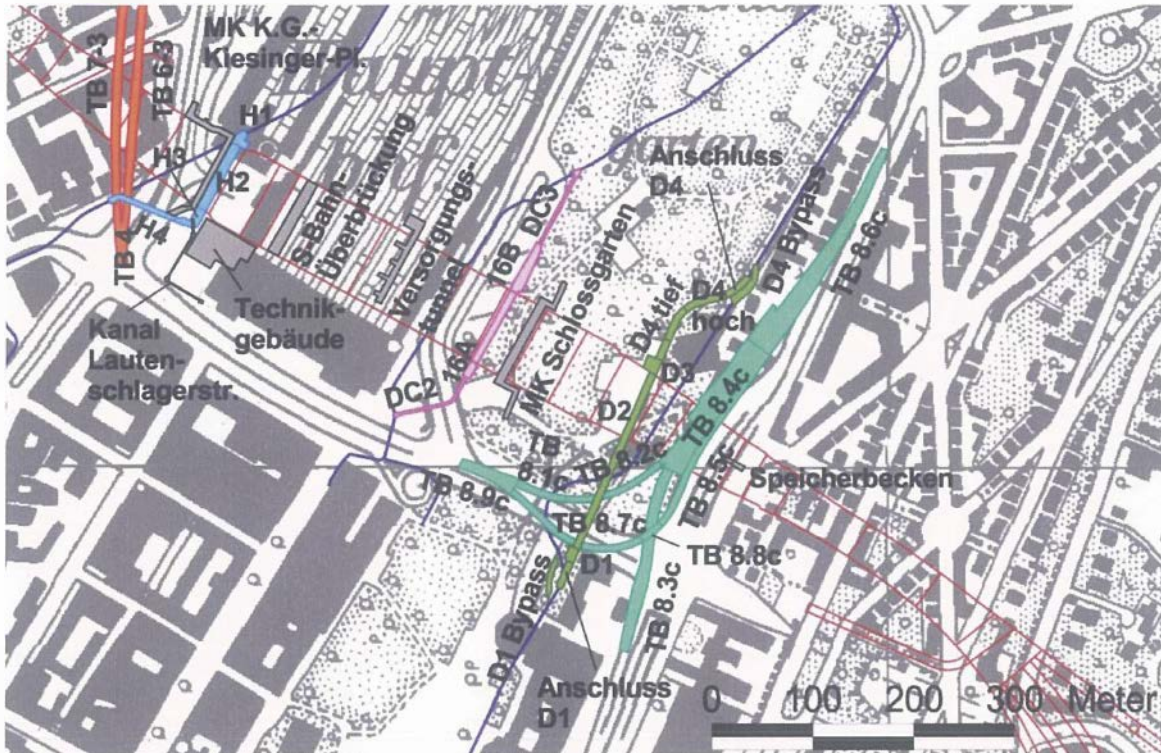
Baugrubenunterteilung und Bezeichnung gemäß planfestgestellter Dükervariante
